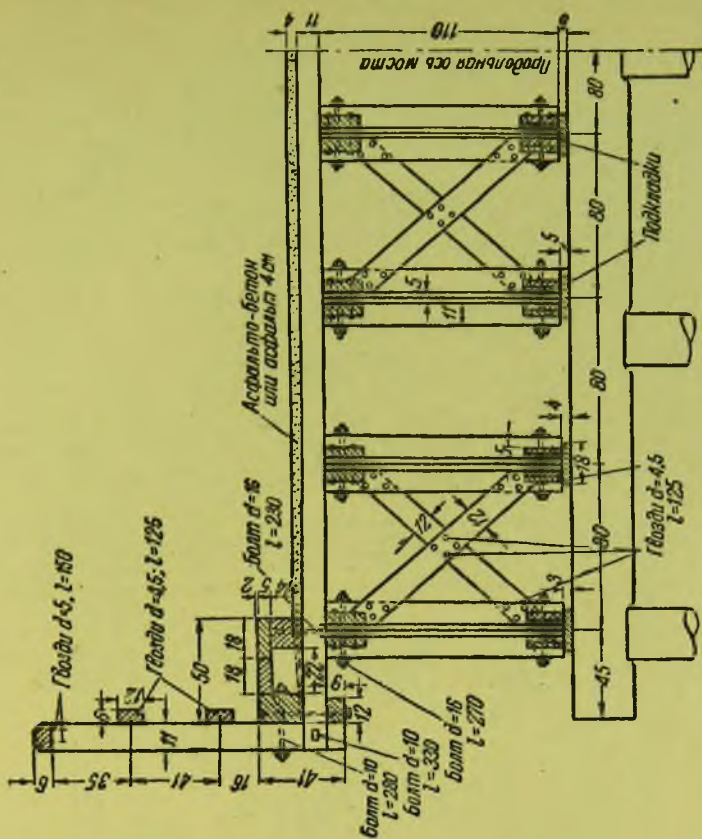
Деталь пояса дощатой гвоздевой фермы.
